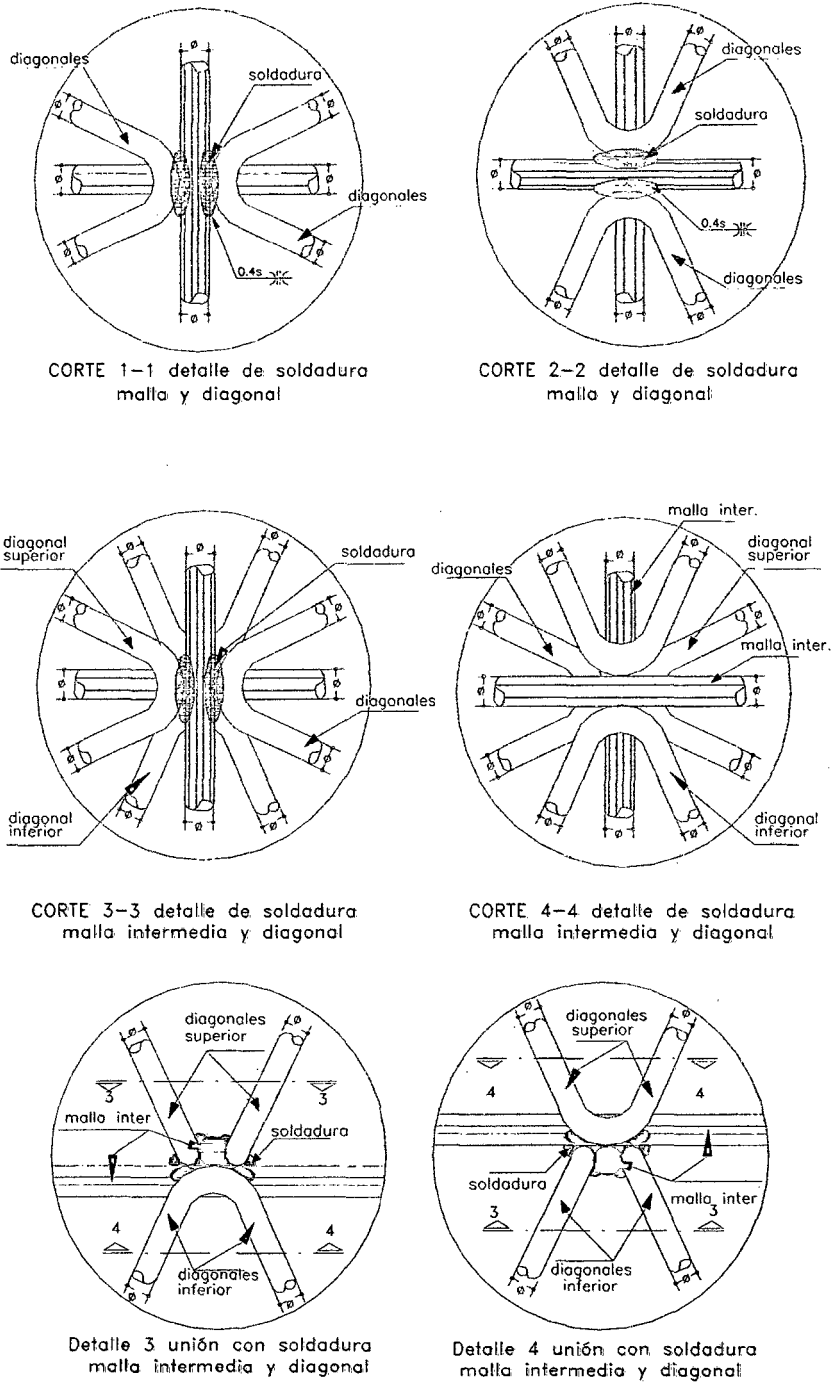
Detalles de soldadura en mallas y diagonales.
